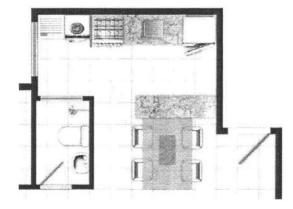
Ilustração de planta de cozinha do tipo parede única. (Fonte: autor)
